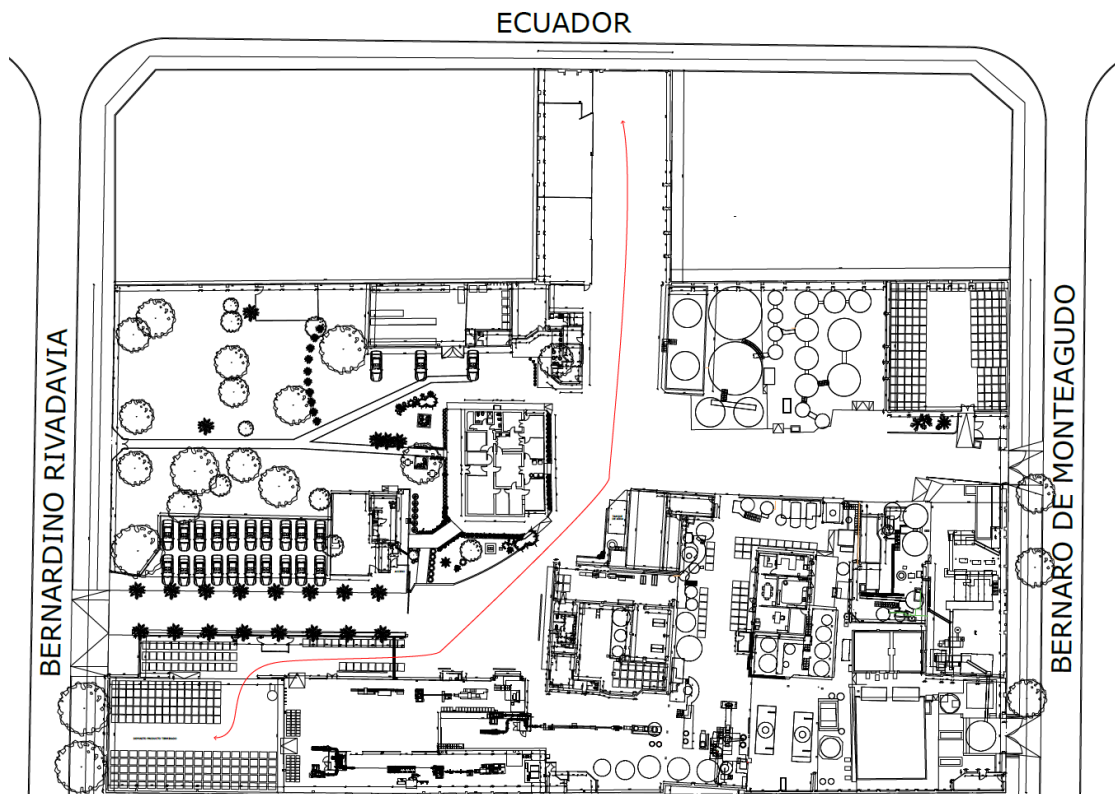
Recorte del plano de planta y recorrido del autoelevador desde dicho sector hasta la salida ubicada sobre la calle Ecuador.
